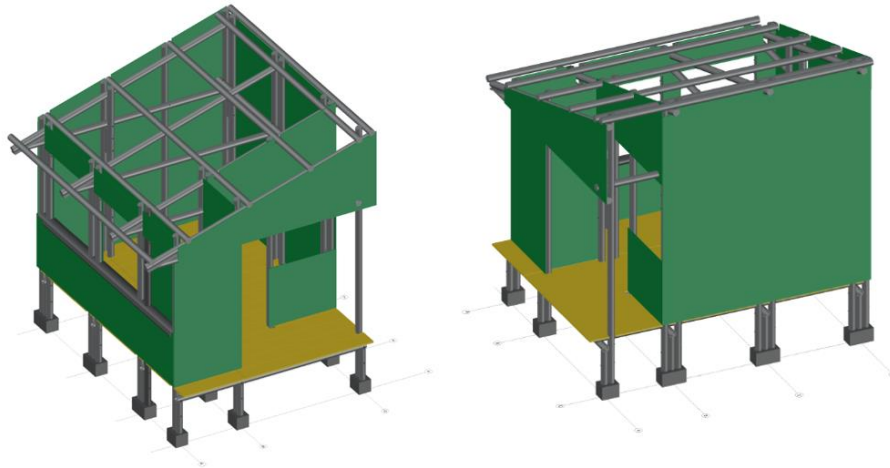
Proceso instalación de cerramiento con esterilla en parte altas de la fachada. Fuente: Elaboración Propia.
